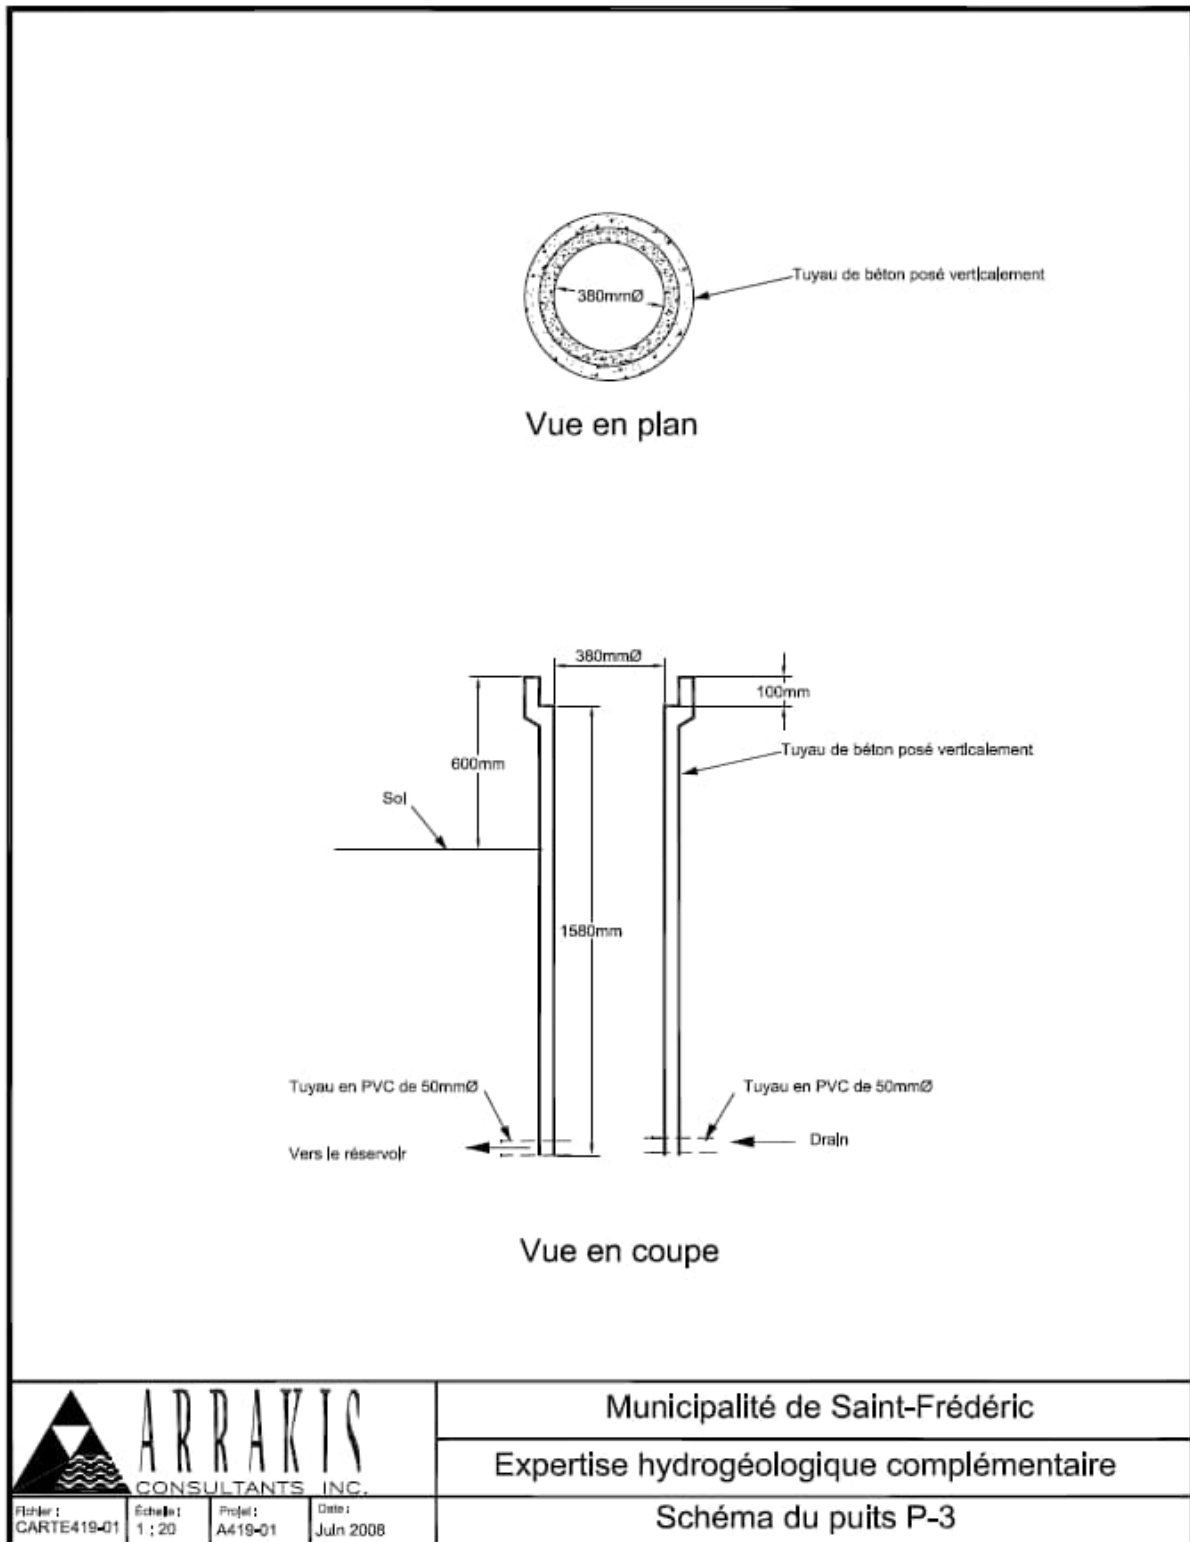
Vue en coupe de la construction de l'installation de prélèvement X2002616-2 (Puits P-3)
